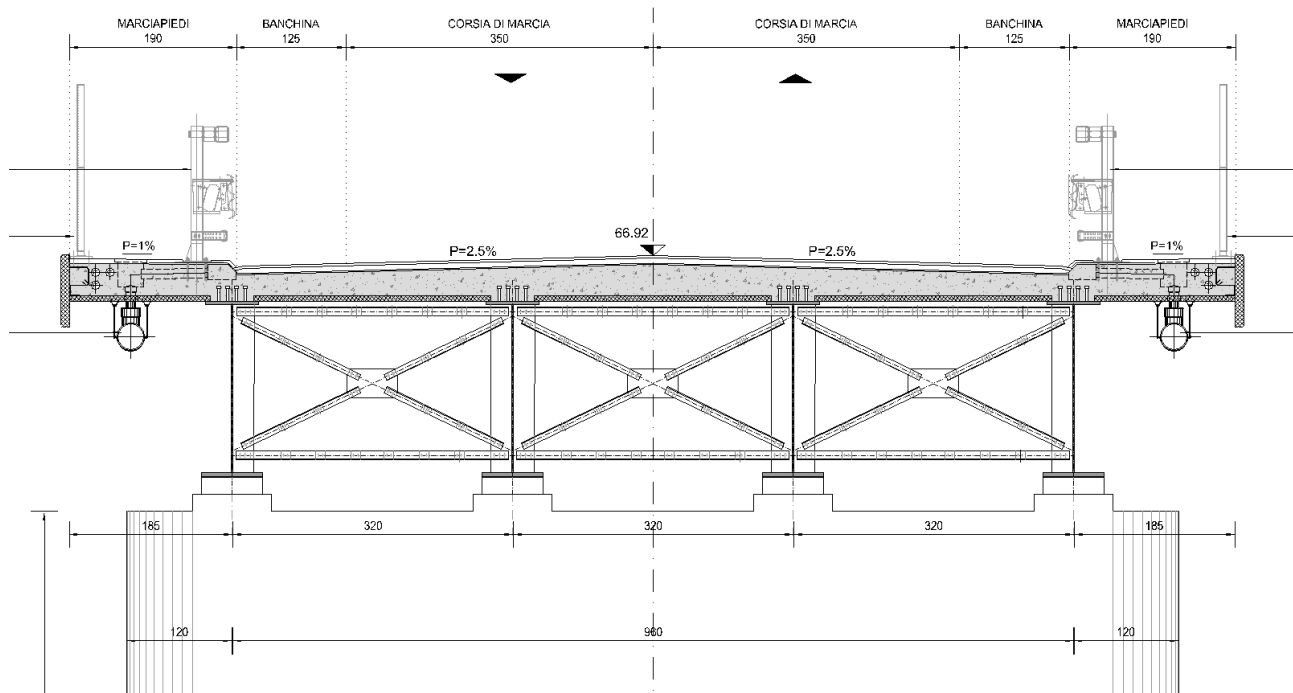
SEZIONE IMPALCATO (SU PILA)
